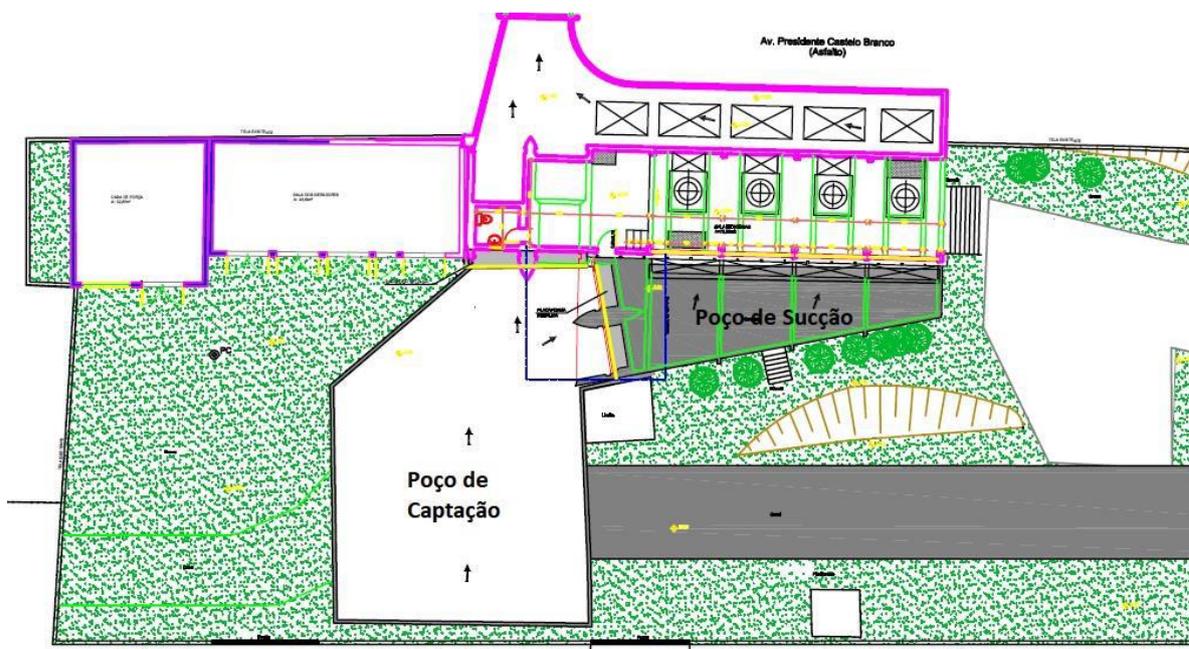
Planta Baixa – Poços de Captação e Sucção.
